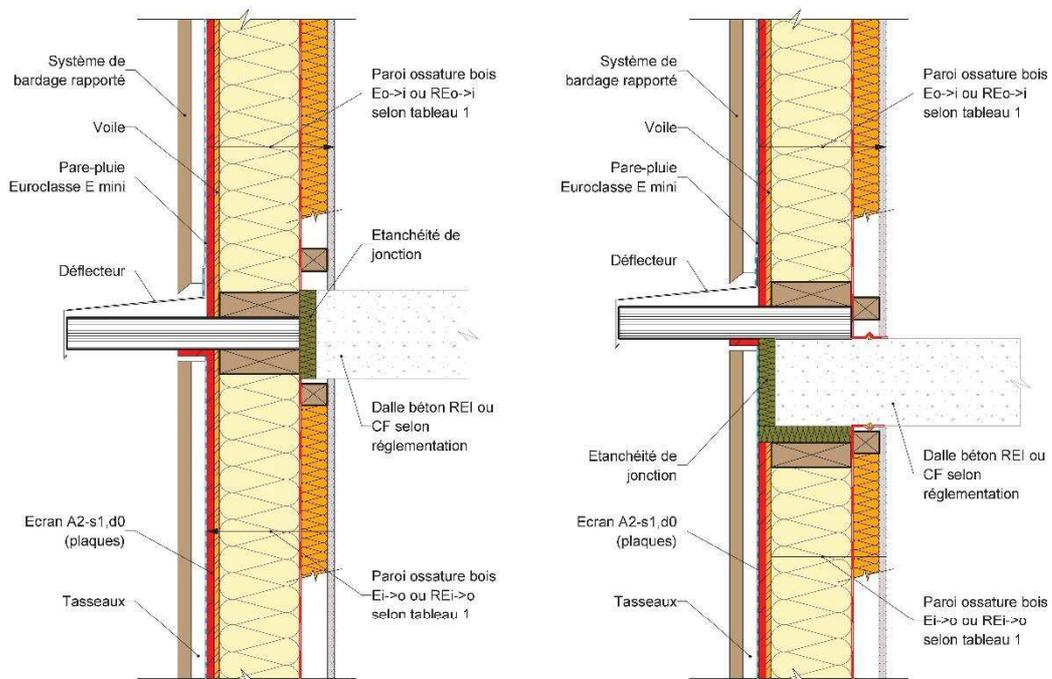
Exemple de paroi avec déflecteurs renforcés d'une Façade ossature bois sur plancher en béton.
